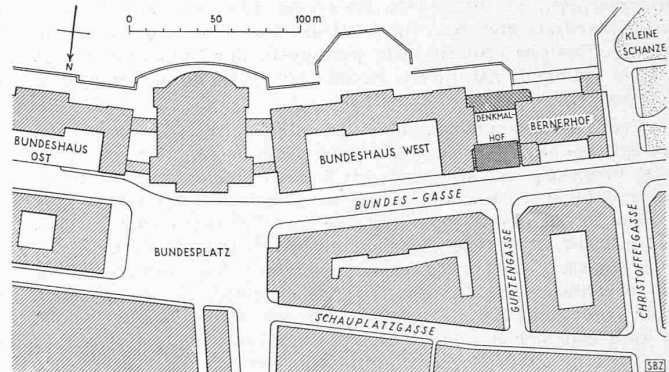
Vorschlag Strässle, Lageplan 1 : 4000 Bew. 3. II. 43, BRB 3. X. 39
